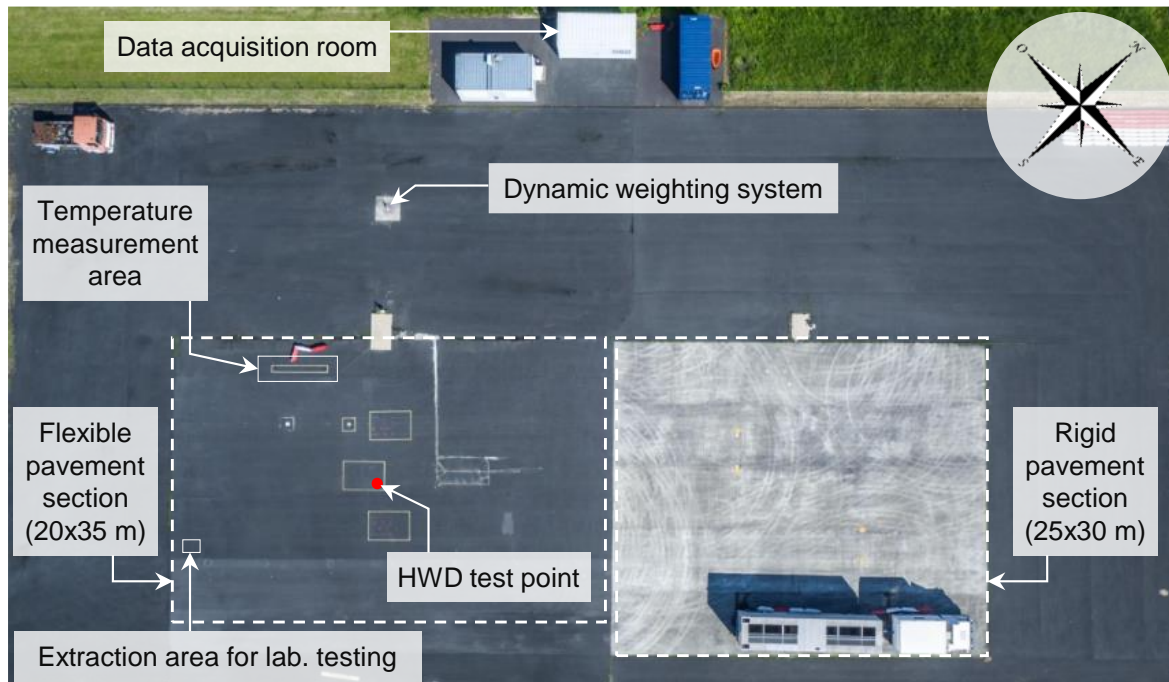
Vue aérienne de la planche d'essais du STAC (photographie STAC)
